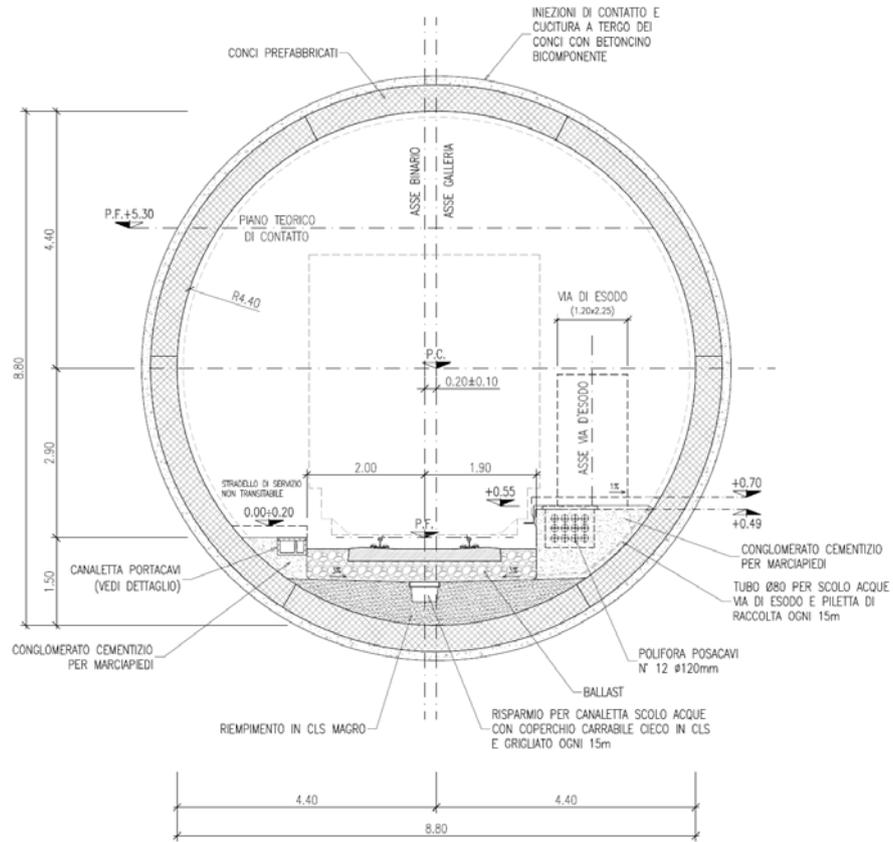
Progetto Esecutivo galleria Lonato, sezione tipo a singolo binario.
